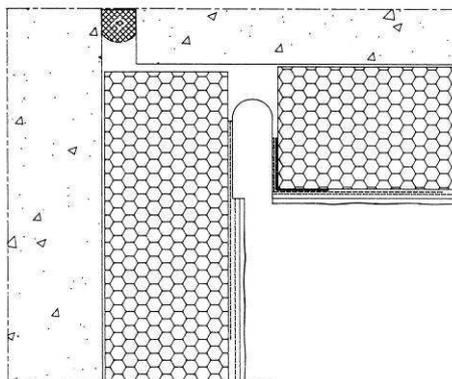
Junta de dilatação estrutural sem perfil cobre-juntas (corte horizontal) [3]
